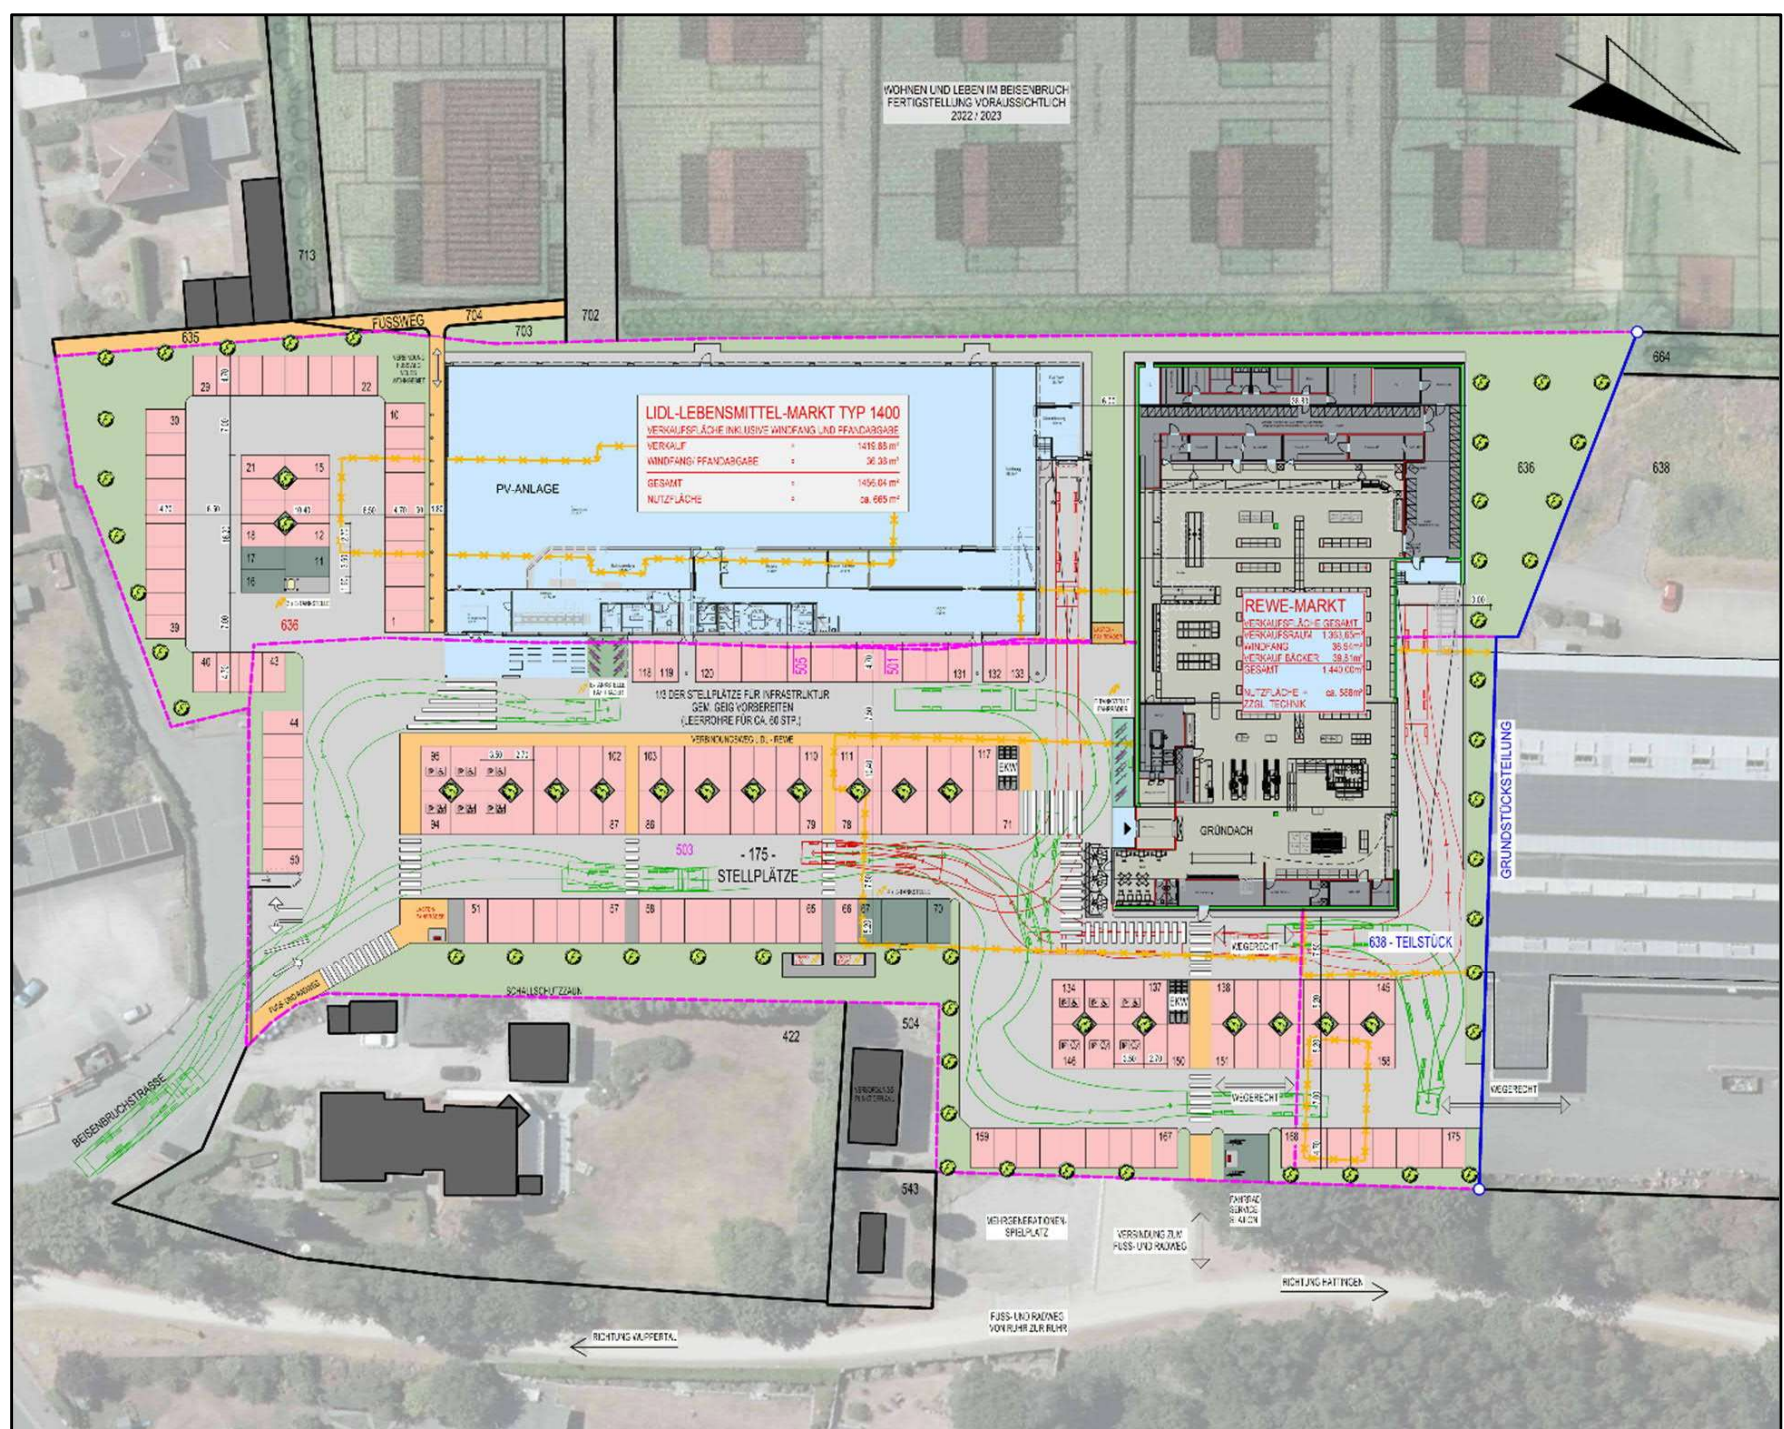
Lageplan des Vorhabens [Quelle: Luckhardt Architekten, Stand: 14.07.2022]
